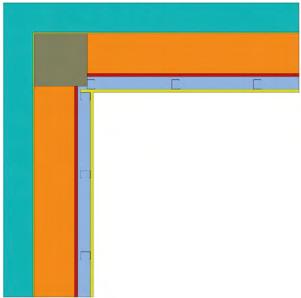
Sistema constructivo de fachada Termoarcilla® SATE.
